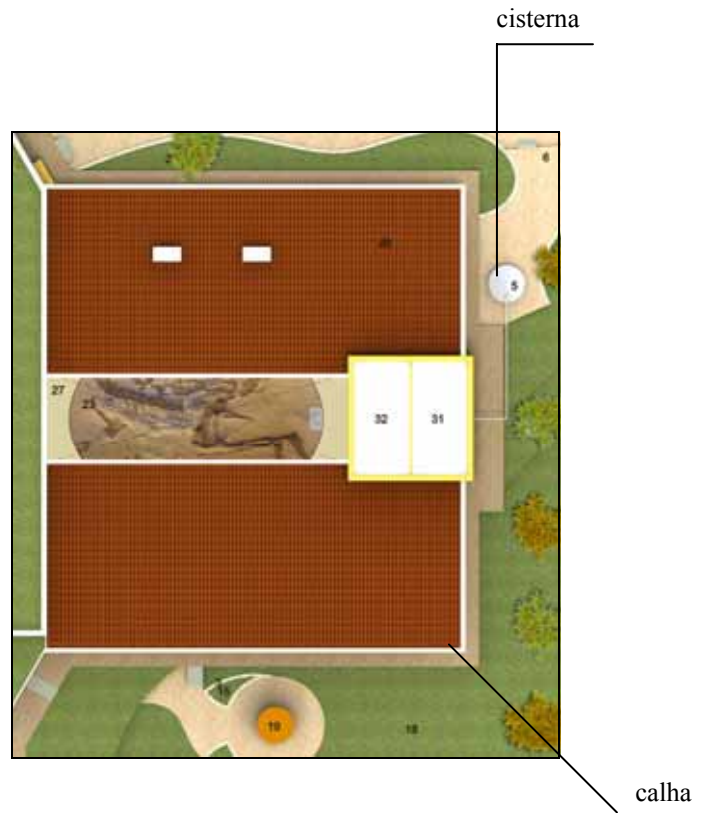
Parte da Planta de Coberta do lado direito do museu
